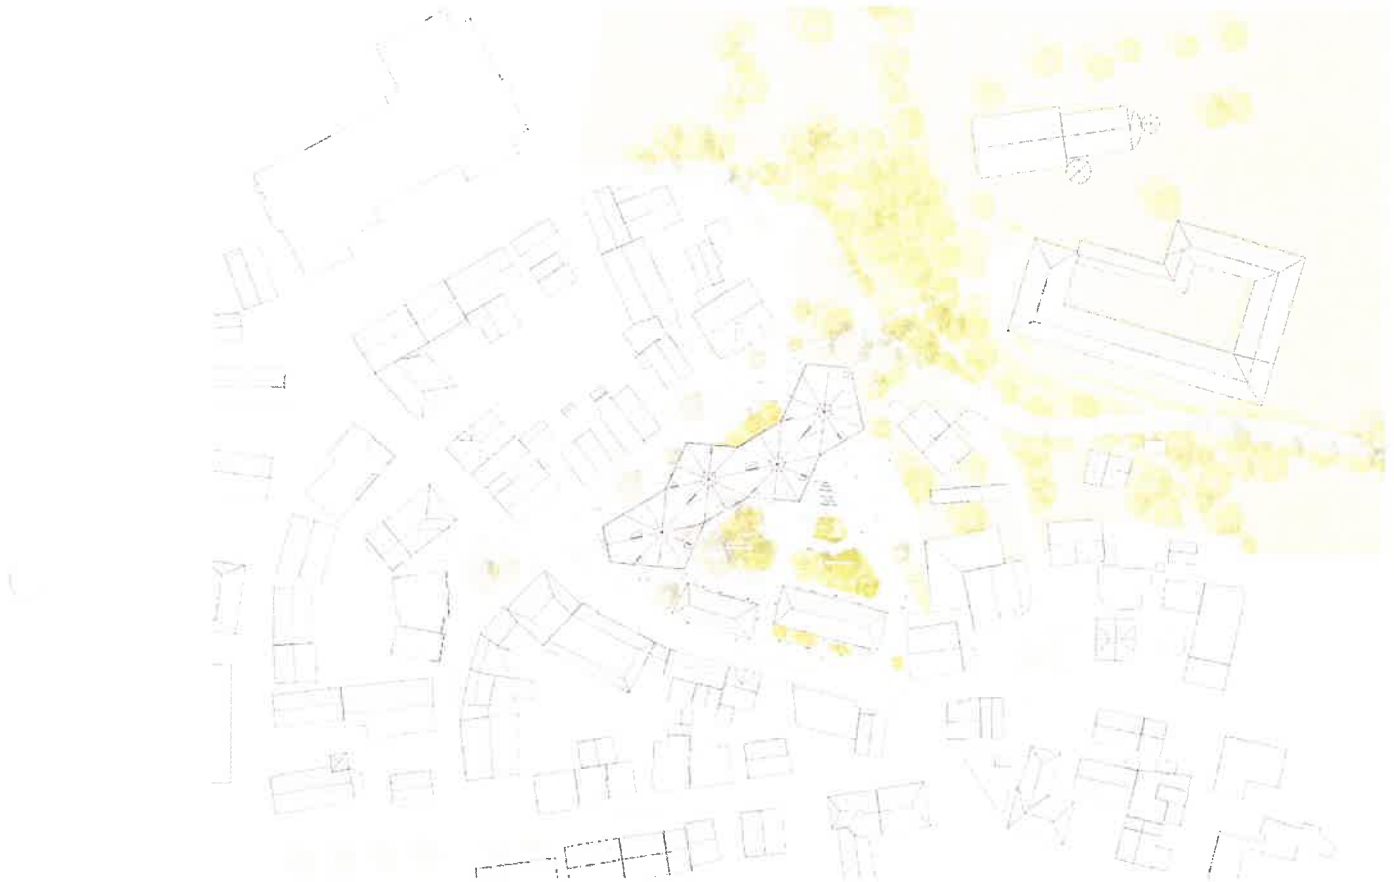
Städtebauliches Grundkonzept (Quelle: Hess / Talhof / Kusmierz Architekten und Stadtplaner)
